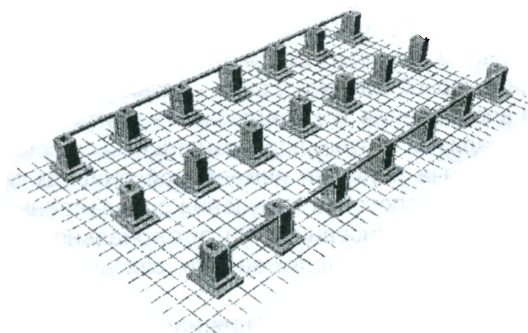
Пространственная модель схемы расположения фундаментов и фундаментных балок
